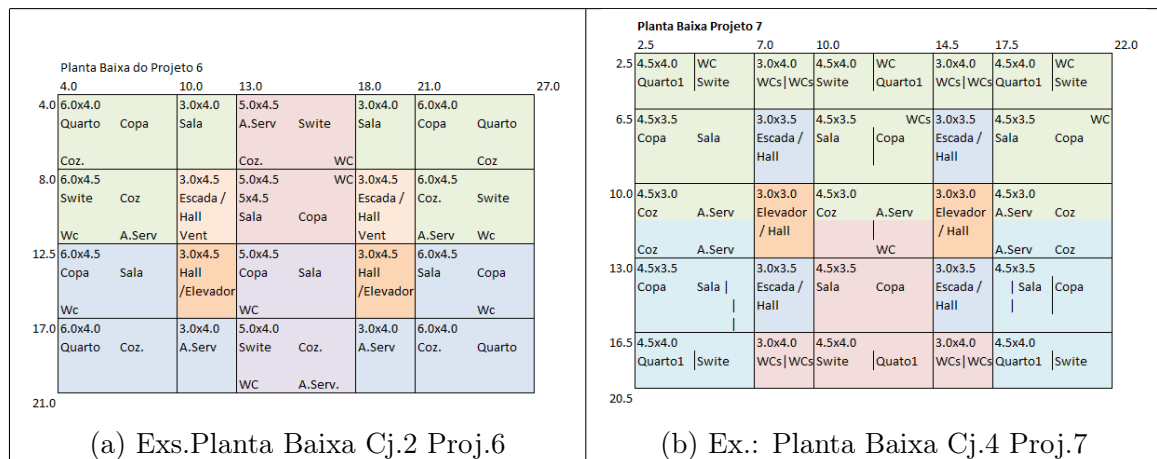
Exs. Plantas Baixas - Conjs Projs. para Dimensionamento
